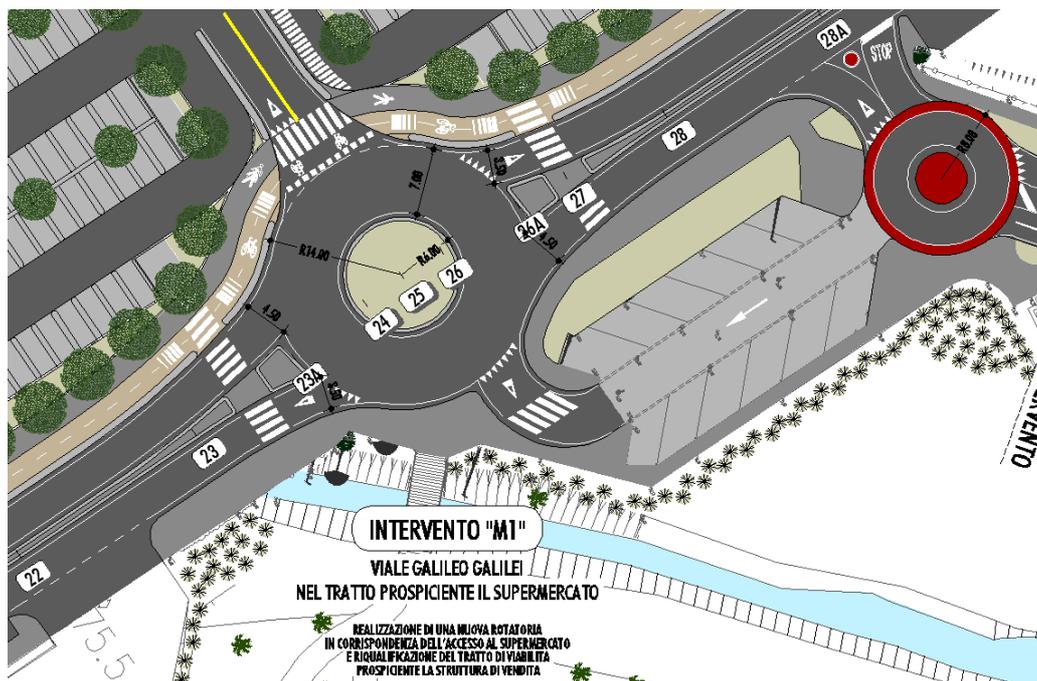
Planimetria di progetto – dettaglio rotatoria
